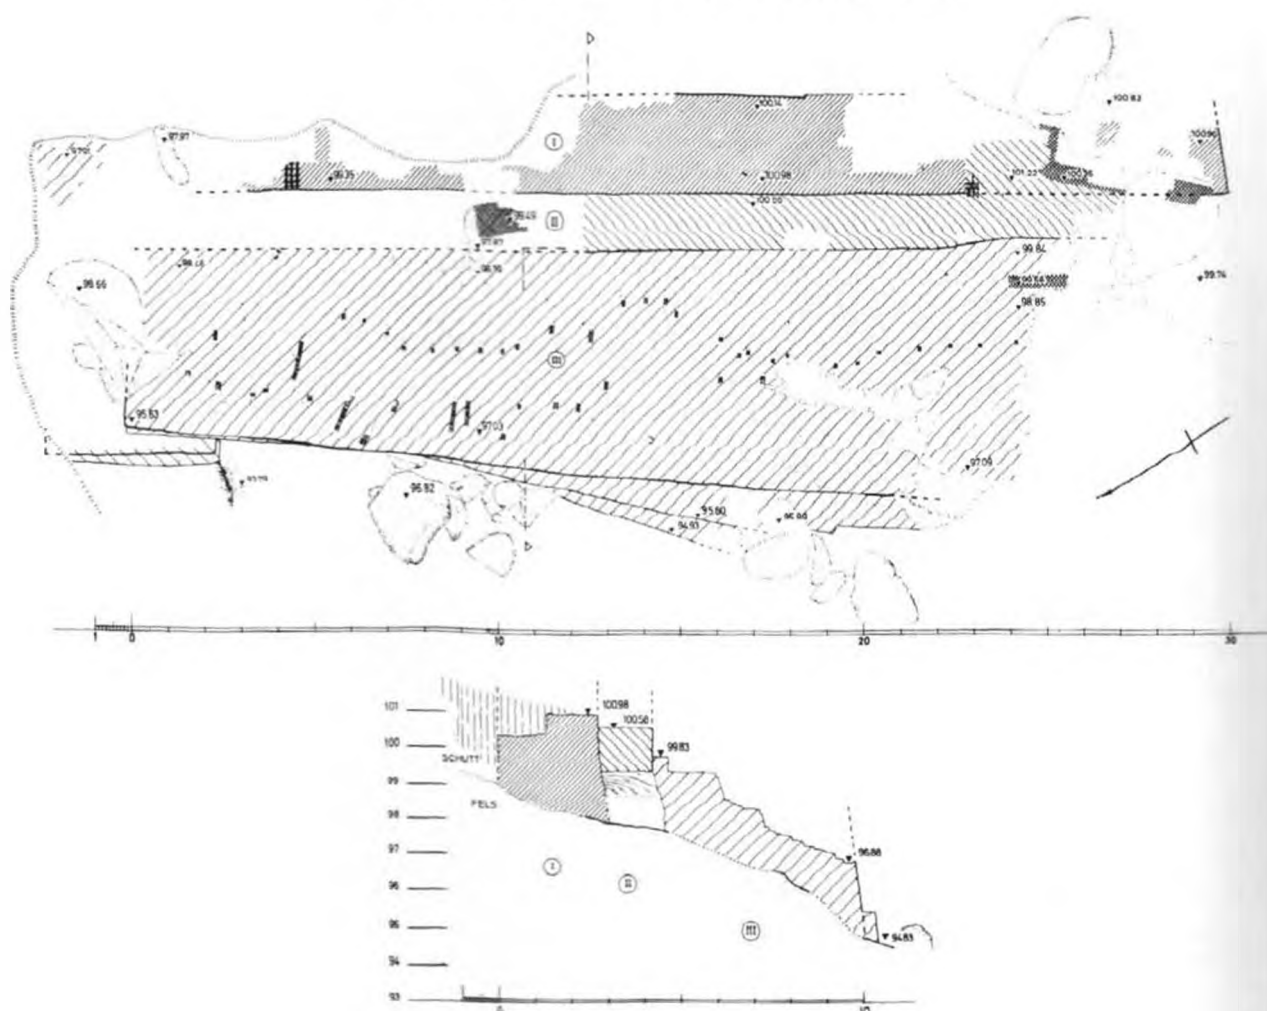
Stadtmauerrest im NW, Massenplan und Schnitt
